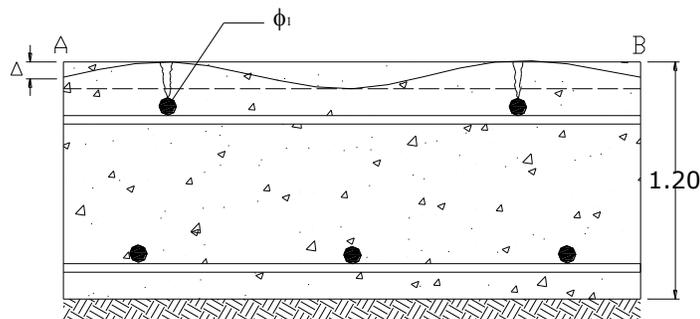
Fisuración sobre el refuerzo debida al asiento plástico
